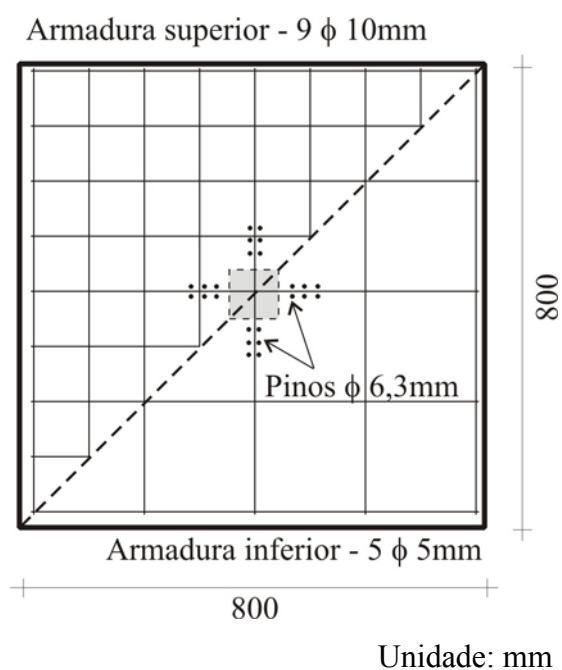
Armaduras de flexão e cisalhamento utilizadas nas lajes de ZAMBRANA VARGAS (1997)
